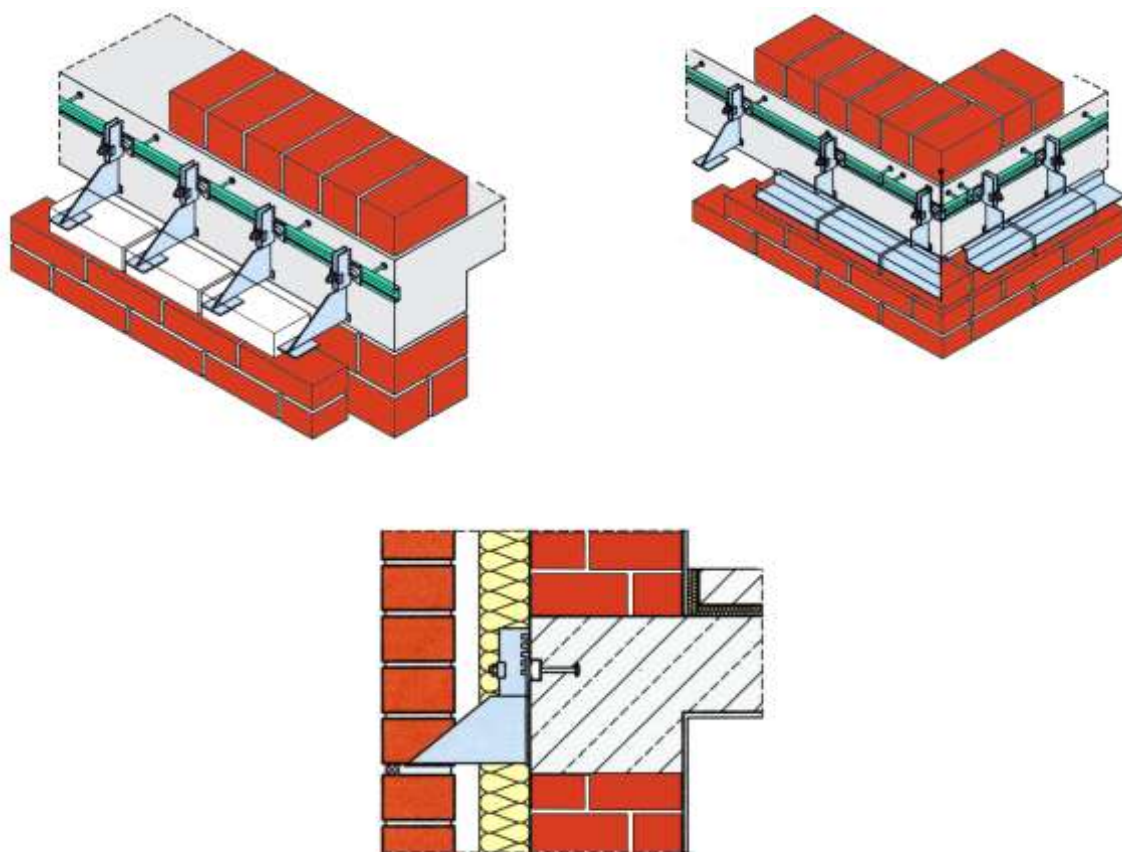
Вариант конструкции наружной стены с опиранием лицевого слоя на стальные кронштейны
